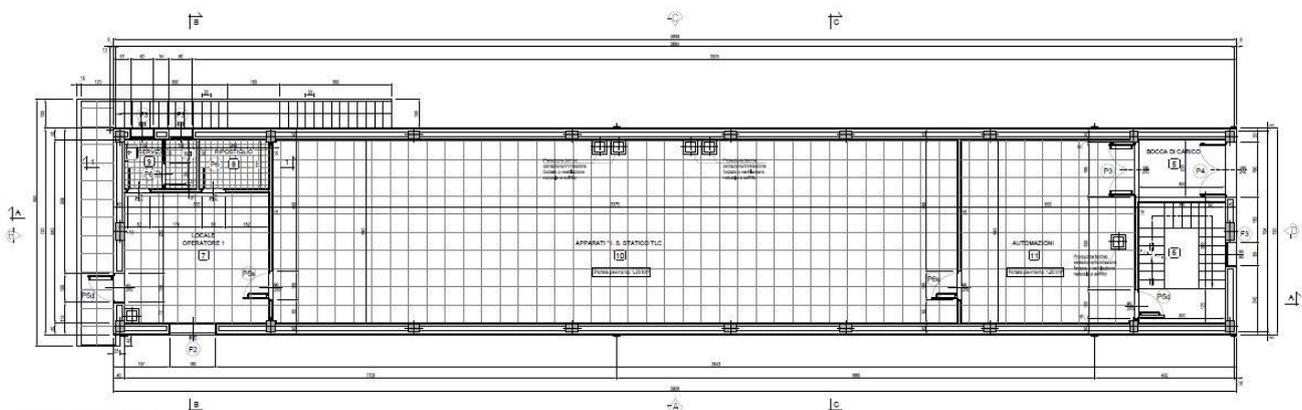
FA1B – Planimetria di inquadramento fabbricato ENEL
